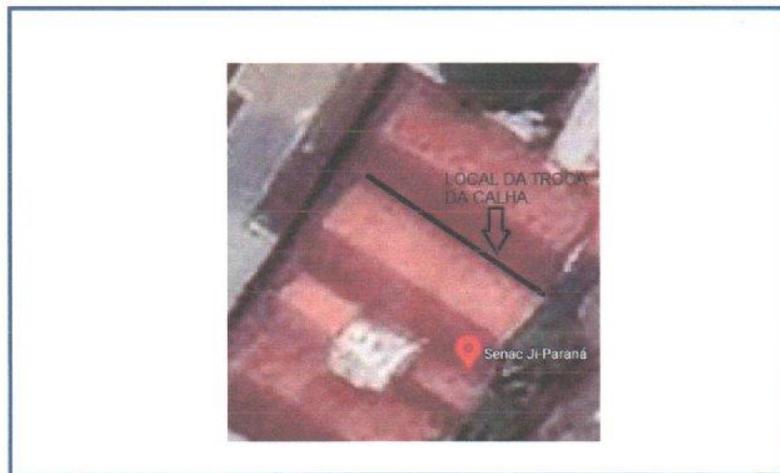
Retirada e instalação de calha metálica sobre cobertura de telha cerâmica.
